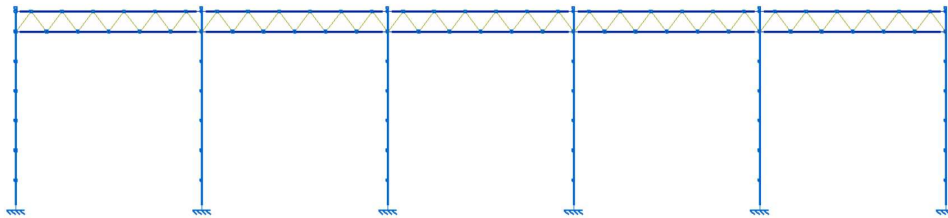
Vista lateral 2D de las vigas laterales de la nave industrial.
